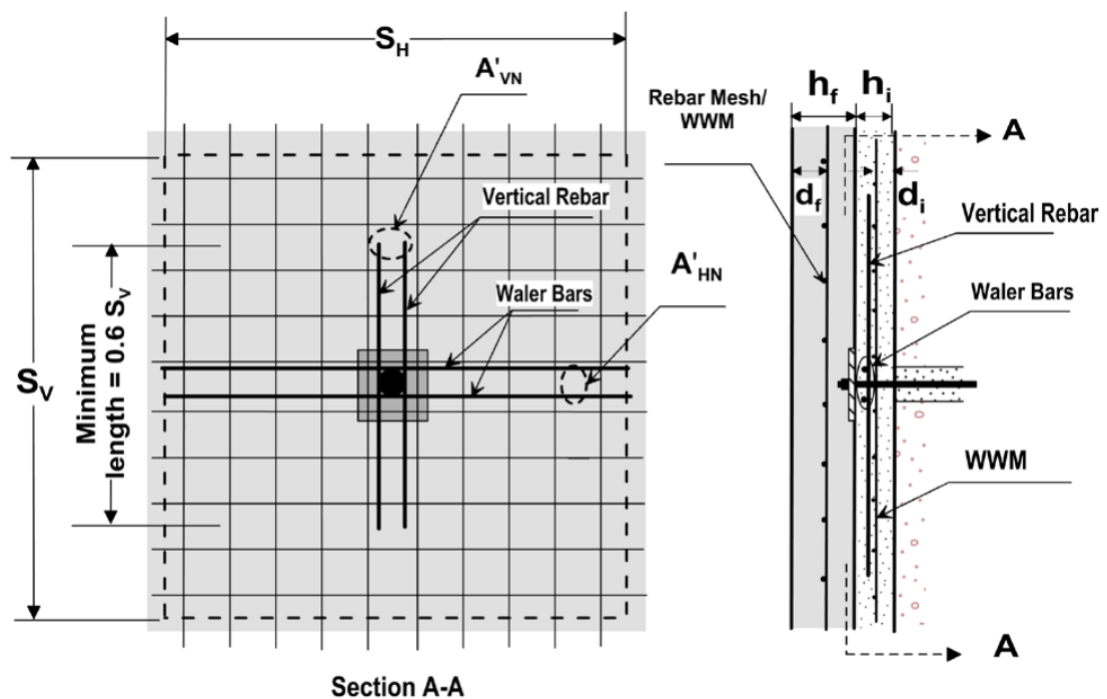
Esquema de colocación de las barras de refuerzo en las cabezas de los clavos (Fuente: *Soil Nail Walls – Reference Manual* (FHWA, 2015))
